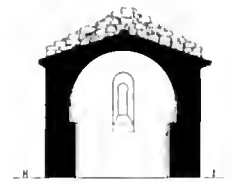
Boada. Secció transversal per H I. Escala 1/200.
